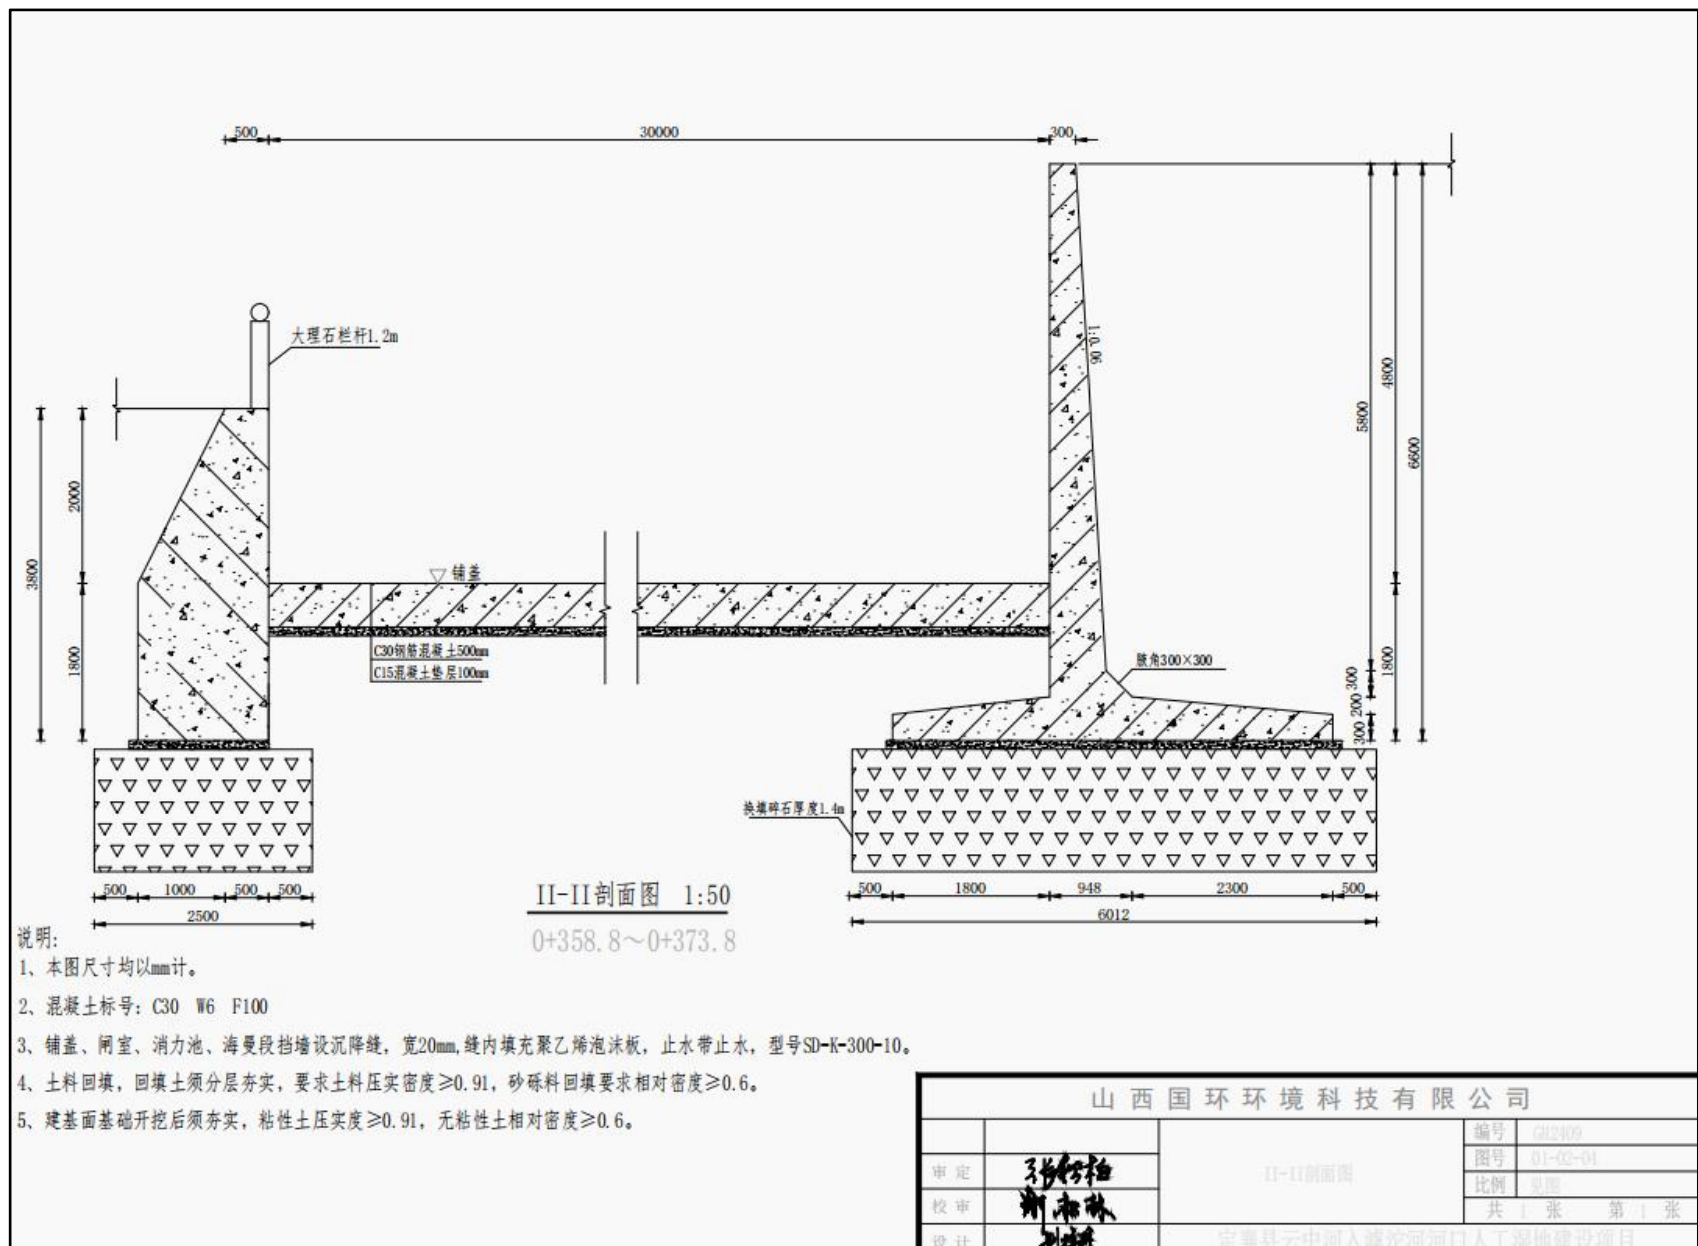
气盾坝 II-II 剖面图 (1: 50)
